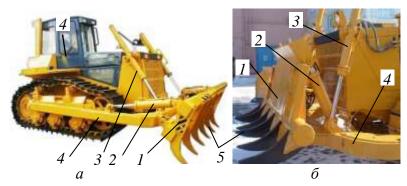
Корчеватель-собиратель: а — корчевальное оборудование МП-18-6; б — корчевальное оборудование МП-19-3; I — отвал; 2, 3 — гидроцилиндры; 4 — рама толкающая; 5 — зубья (клыки)
